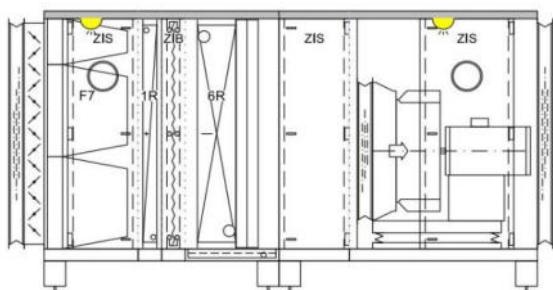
Чертеж агрегата с регулировкой опор по высоте
